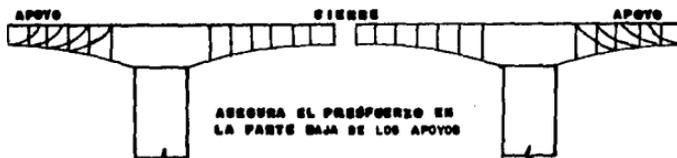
CABLEADO PARA EL ARMADO DE LA ESTRUCTURA
